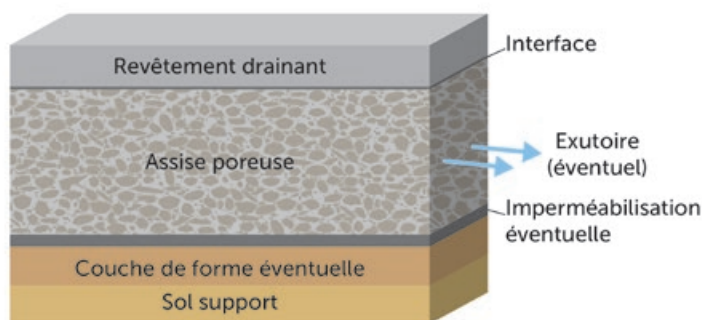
Structure-type d'une voirie à assise poreuse et revêtement drainant.
